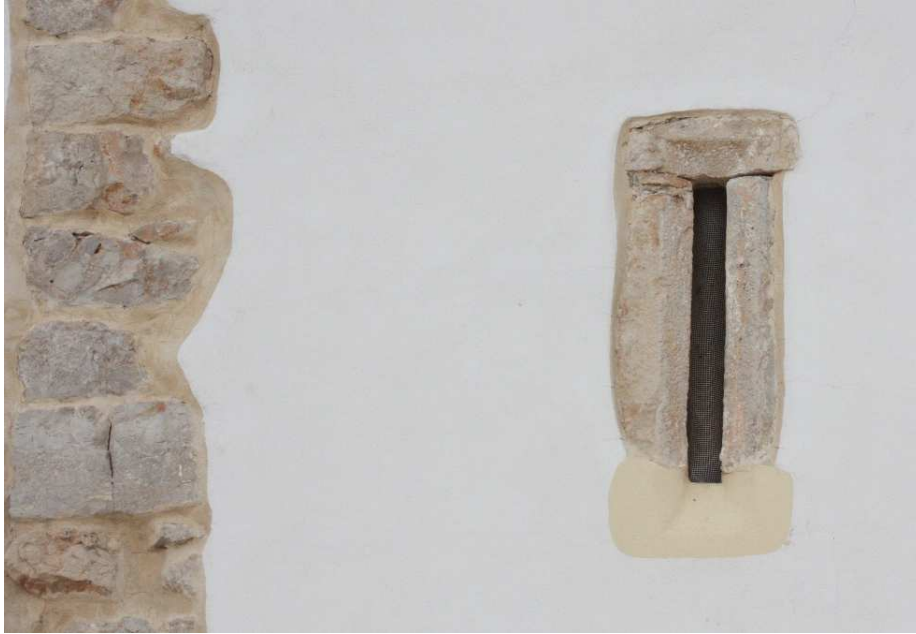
Detalle de la mampostería del muro y de un hueco en la Ermita de Sant Llorenç
